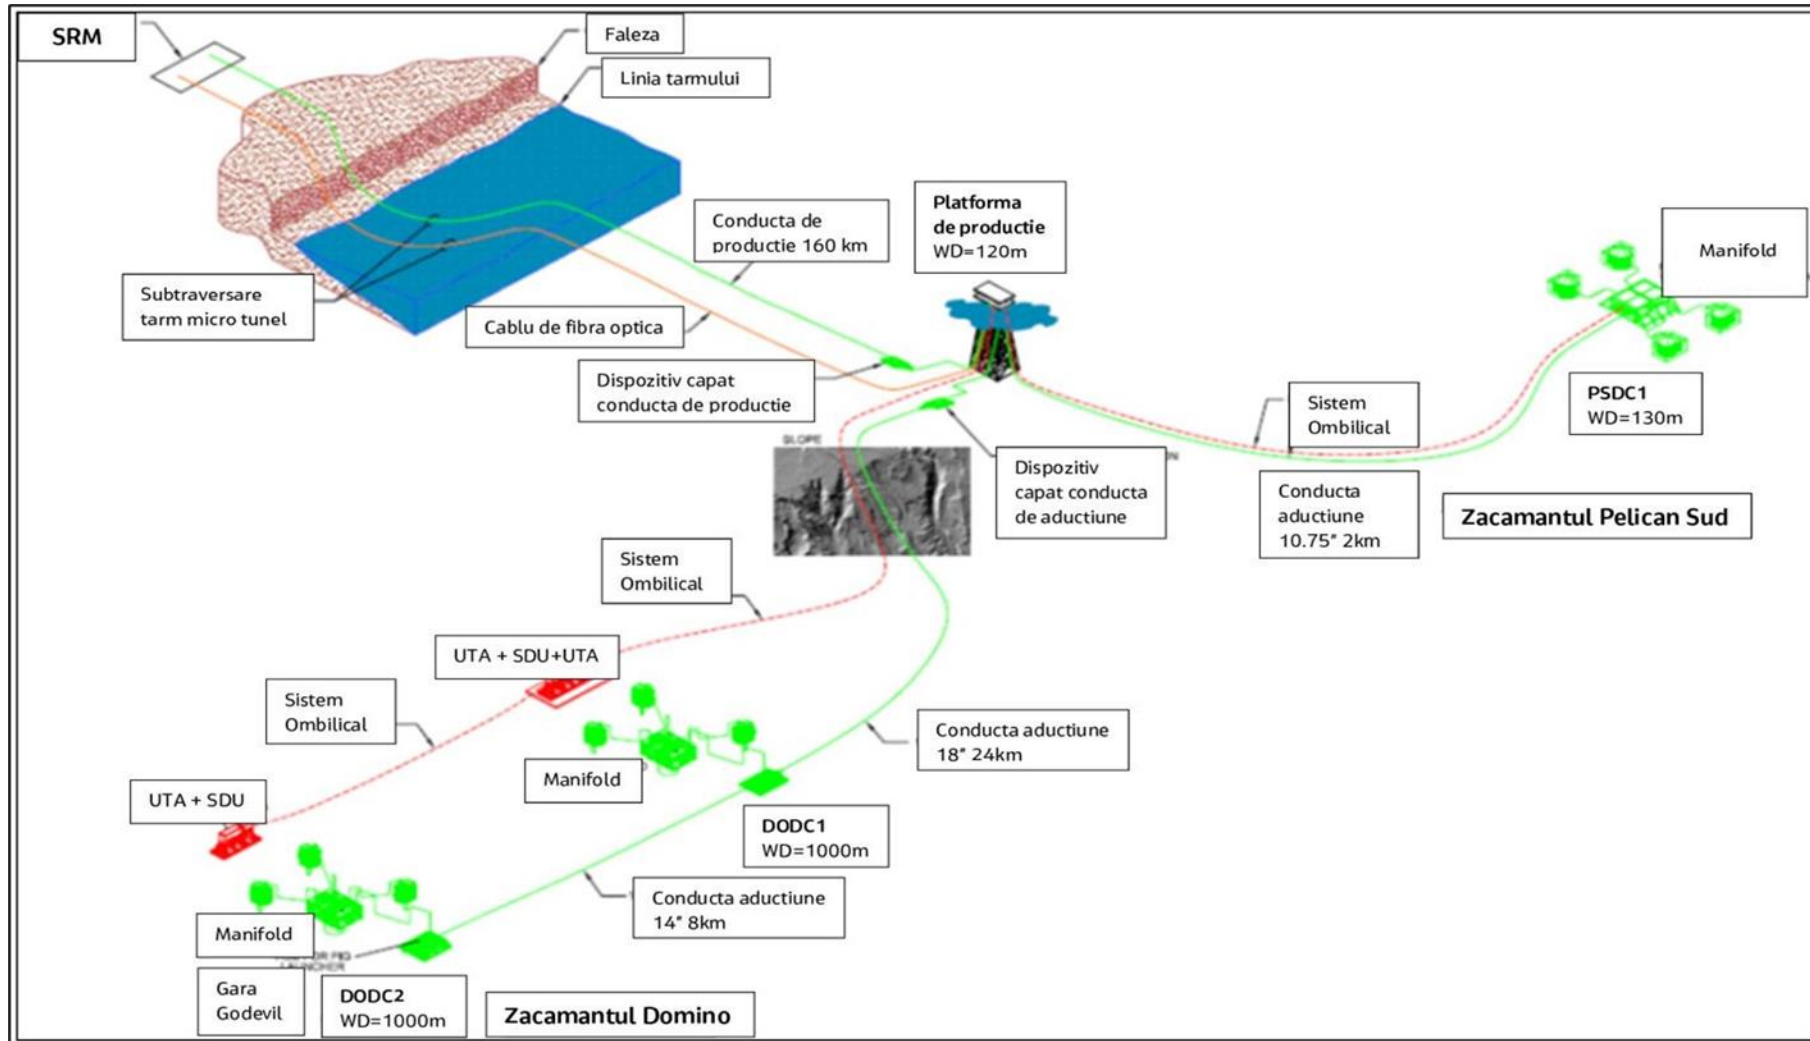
Plan de încadrare a proiectului Neptun Deep
